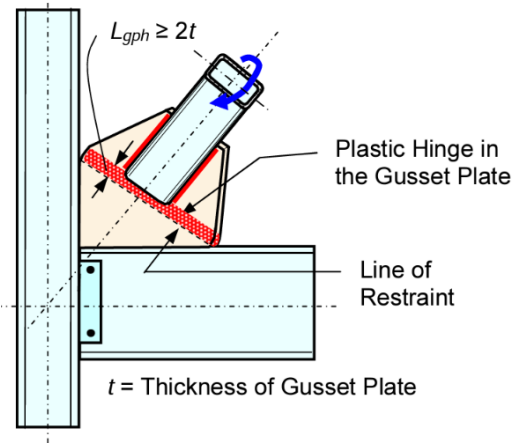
Zona de rótula plástica en plancha gusset para pandeo de arriostramiento fuera del plano. (Fuente: Astaneh-Asl et al, 2006)
